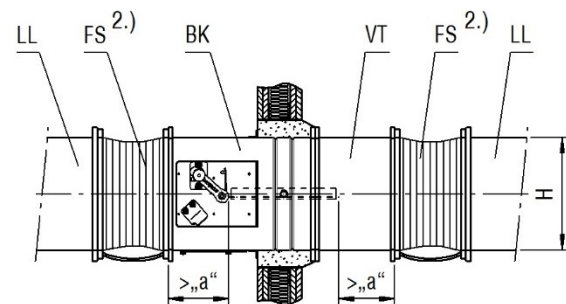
Exemple de raccordement avec manchon flexible sur les deux côtés et conduits d'aération
